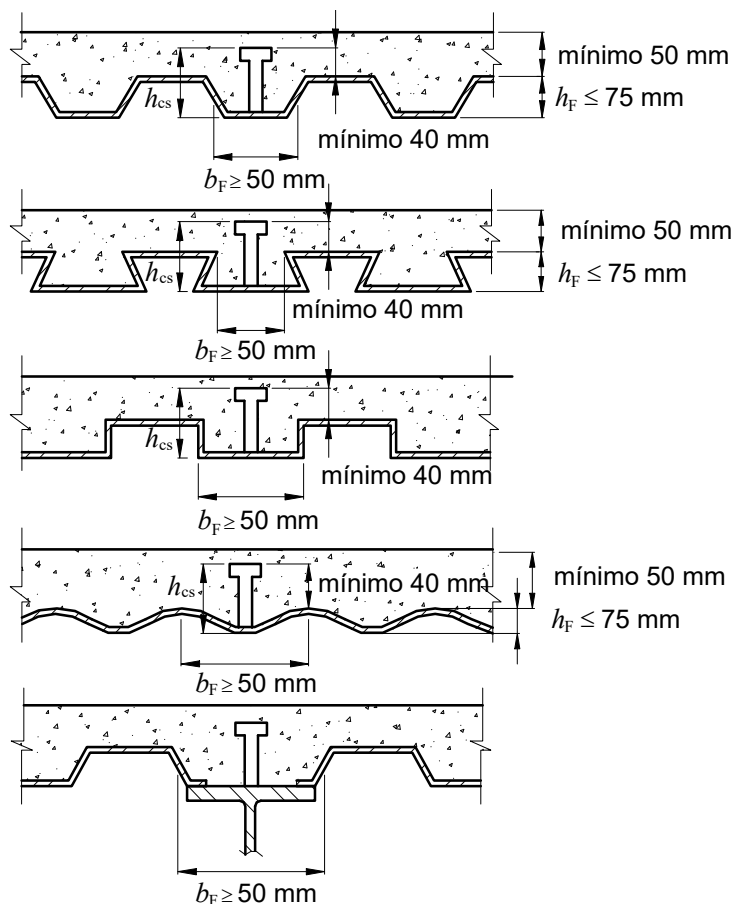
Lajes de concreto com fôrma de aço incorporada
